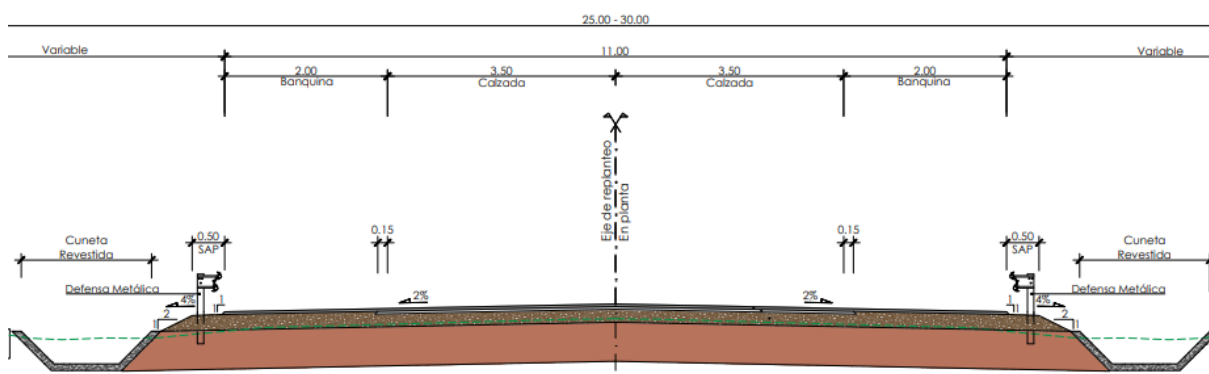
Sección tipo de obra básica y estructura de pavimento, Gral. Bruguez
